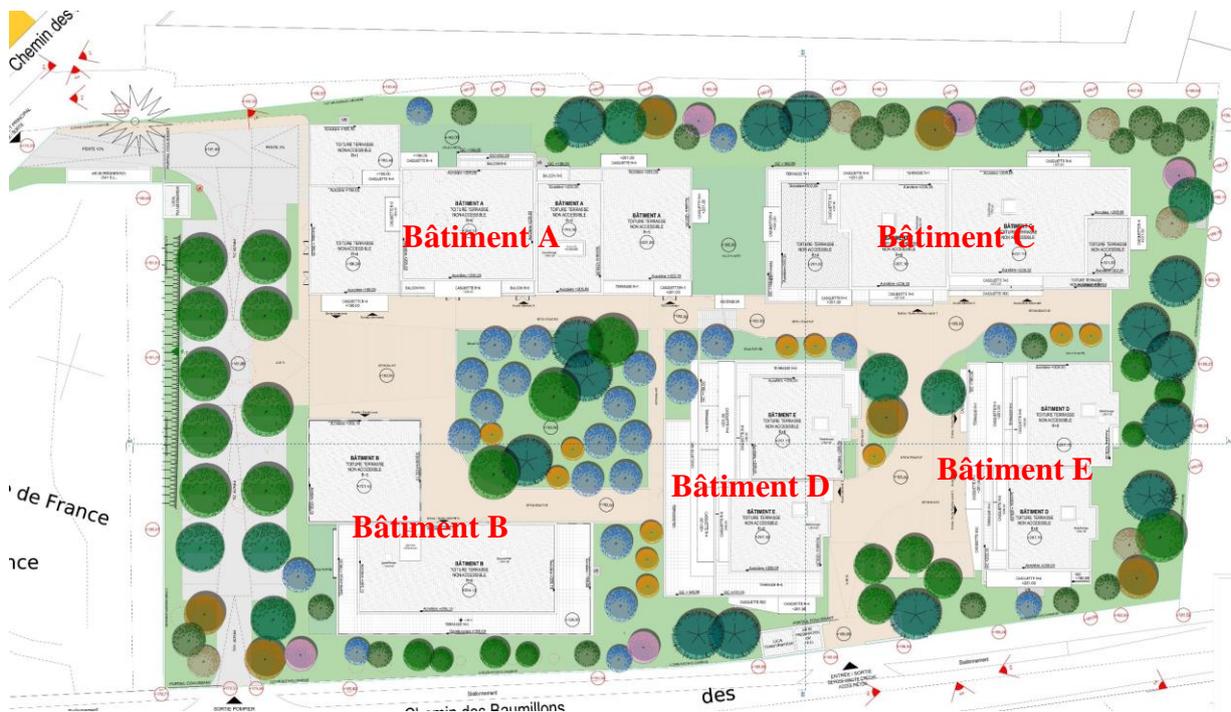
Plan de masse du projet (Source : Kaufman & Broad)
